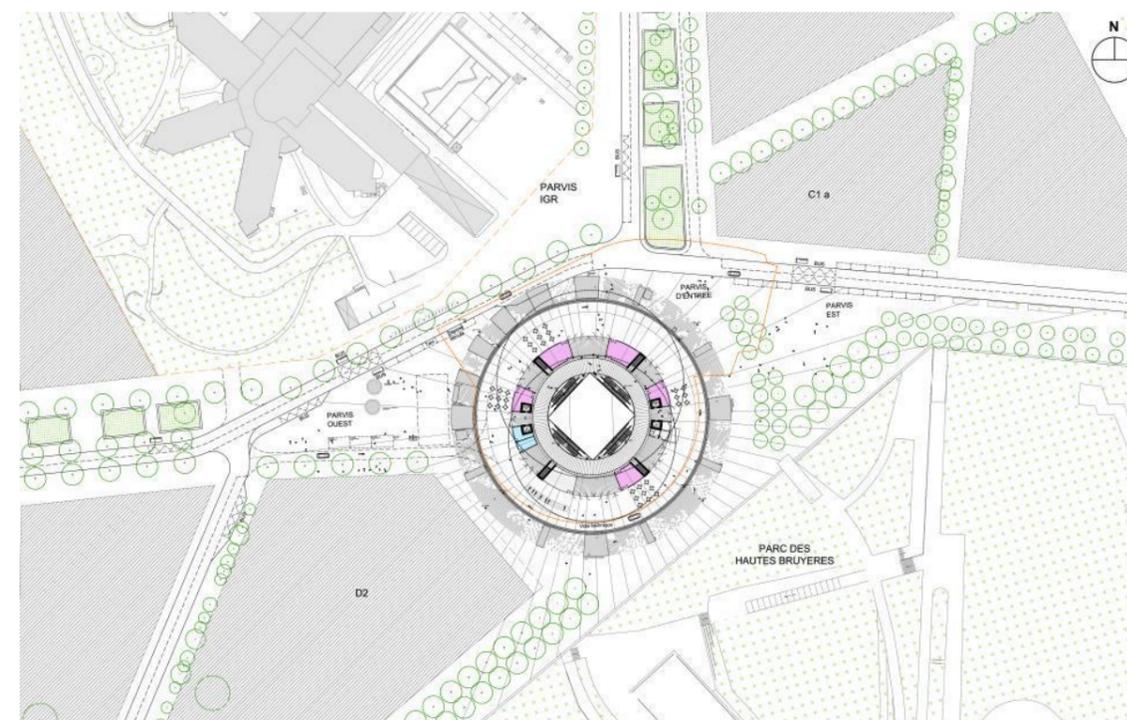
Gare de Villejuif IGR – Plan d’implantation
